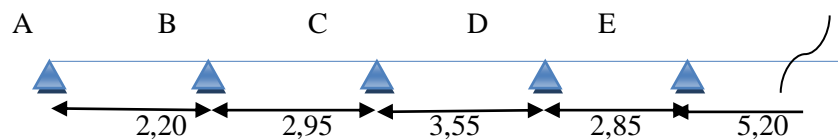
Les types des poutrelles de plancher Etages courants et RDC.
